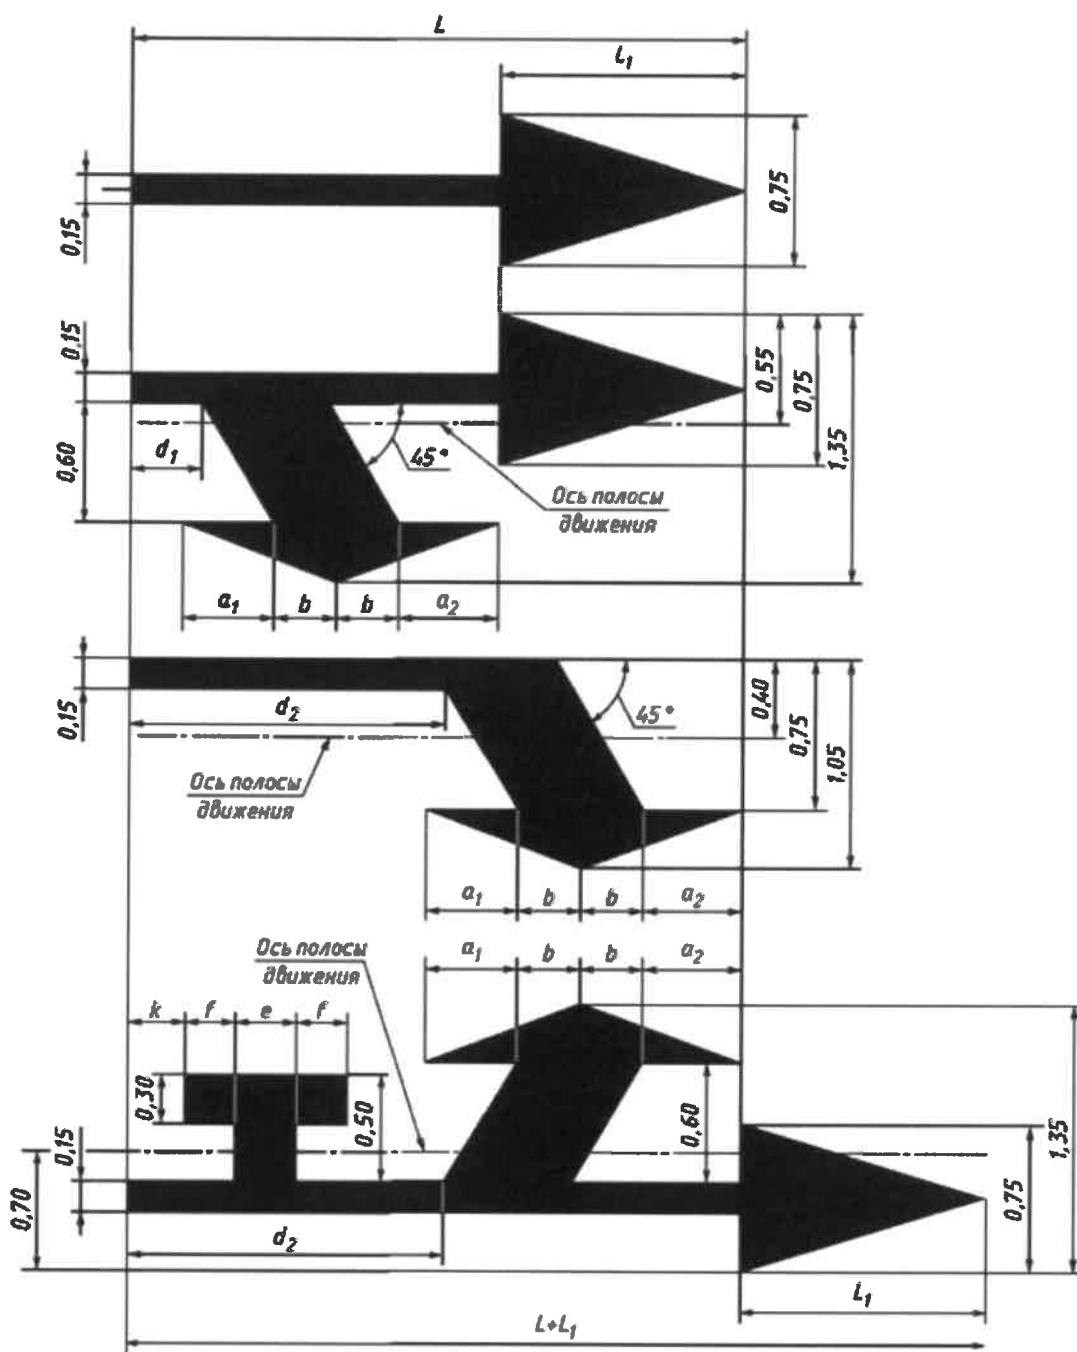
Форма и размеры стрел разметки типа 1.18
